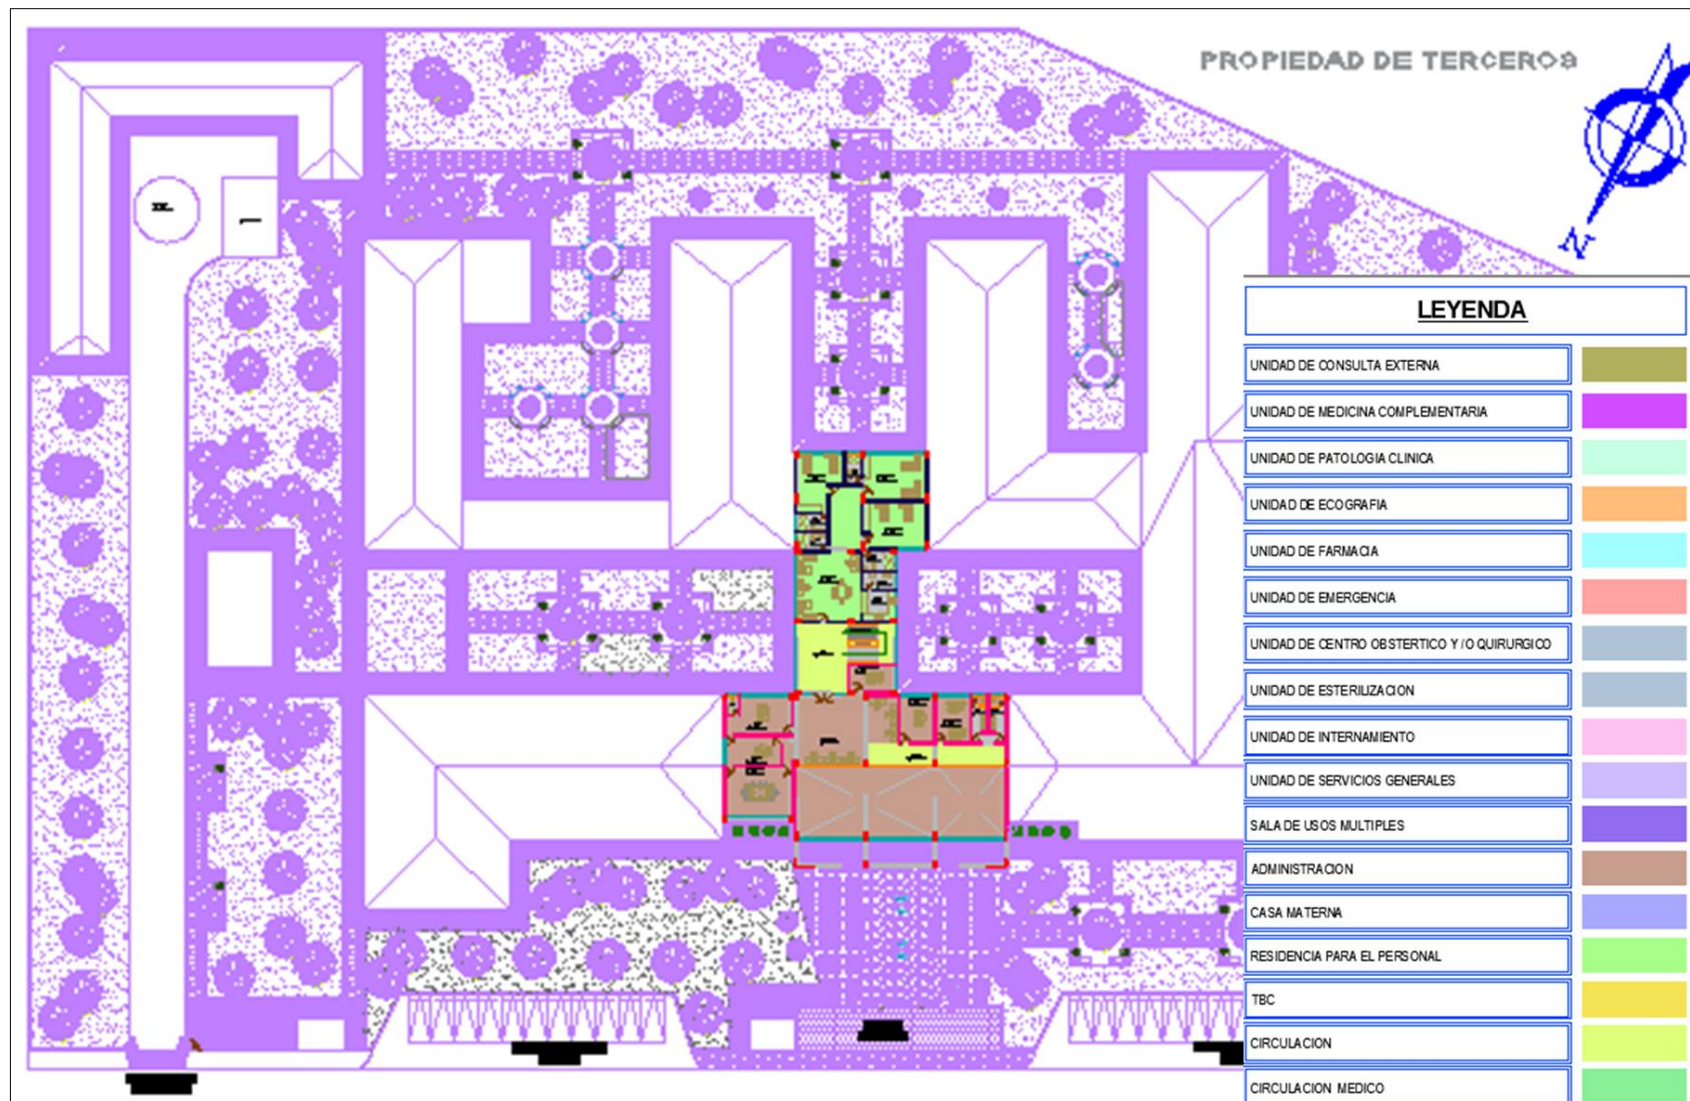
Zonificación 2° planta; Fuente: elaboración propia.
